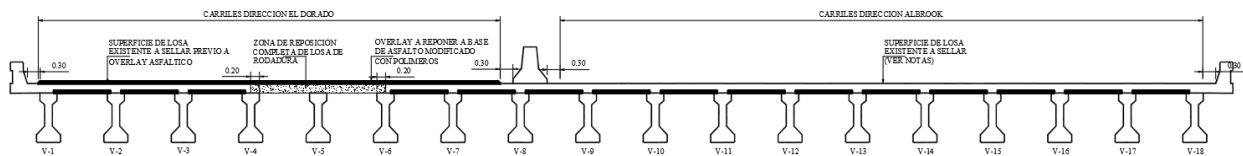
Arreglo Esquemático de Tablero del Puente
